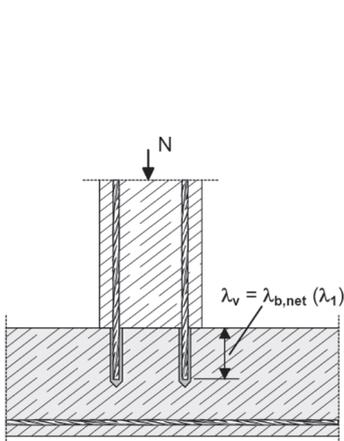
Conexiones de armaduras para elementos sometidos principalmente a compresión. Las armaduras son sometidas a compresión.
